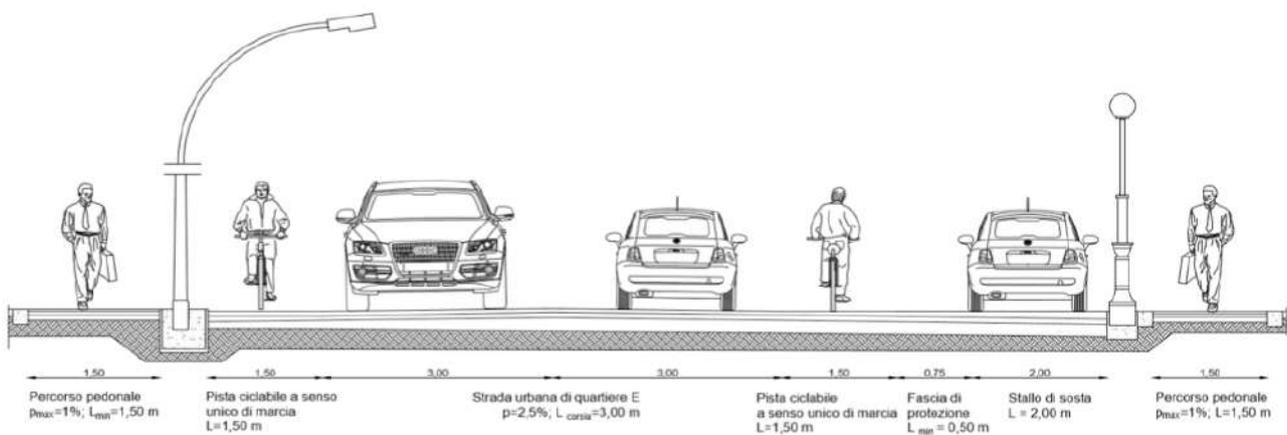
Piste ciclabili su corsia riservata in carreggiata stradale (sezione).
